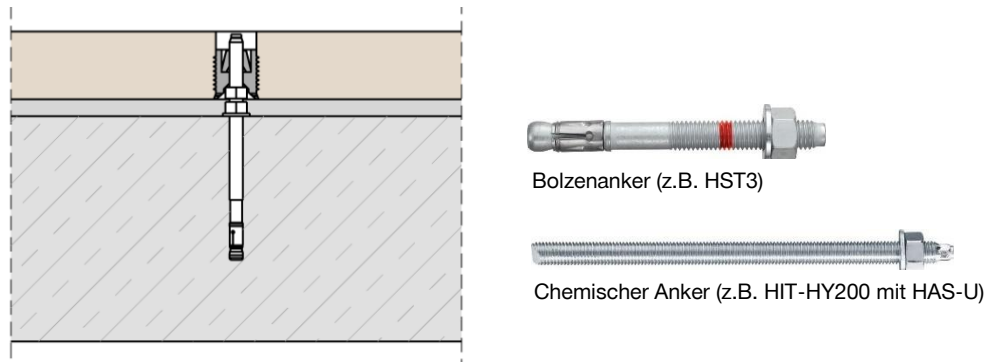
Verbindung zwischen einem Holzelement und einem Betonelement mit HCW und nachträglich eingebauten Dübeln
